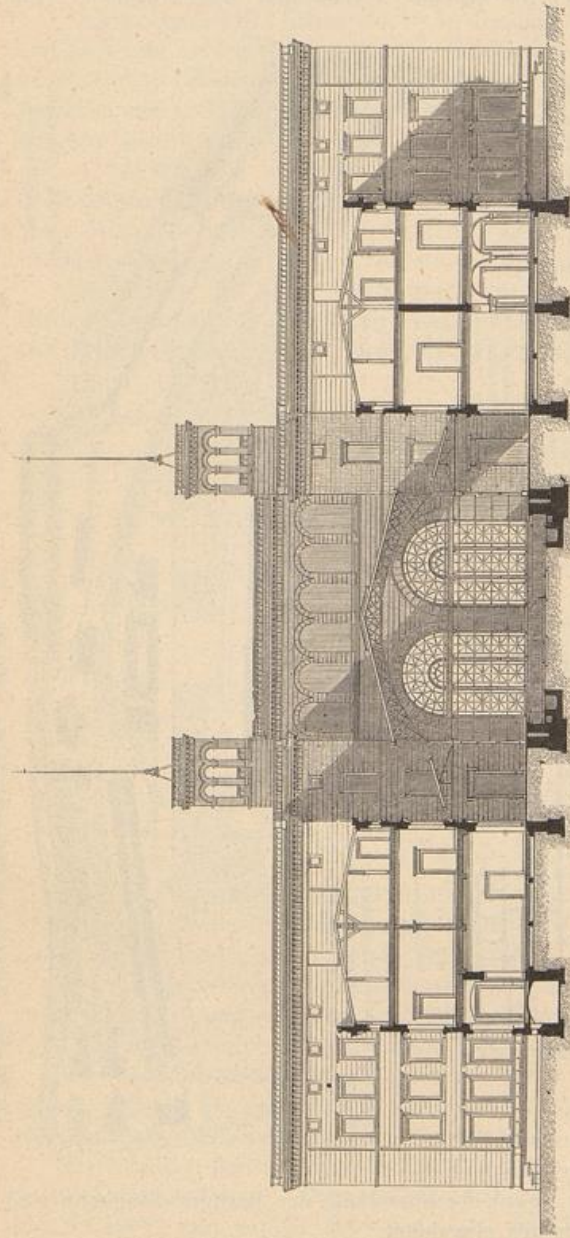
Empfangsgebäude der Berlin-Hamburger-Eisenbahn. Querschnitt durch die Halle und die Räume 4 und 13 des Grundrisses. (M. a. Stab 1:500).
